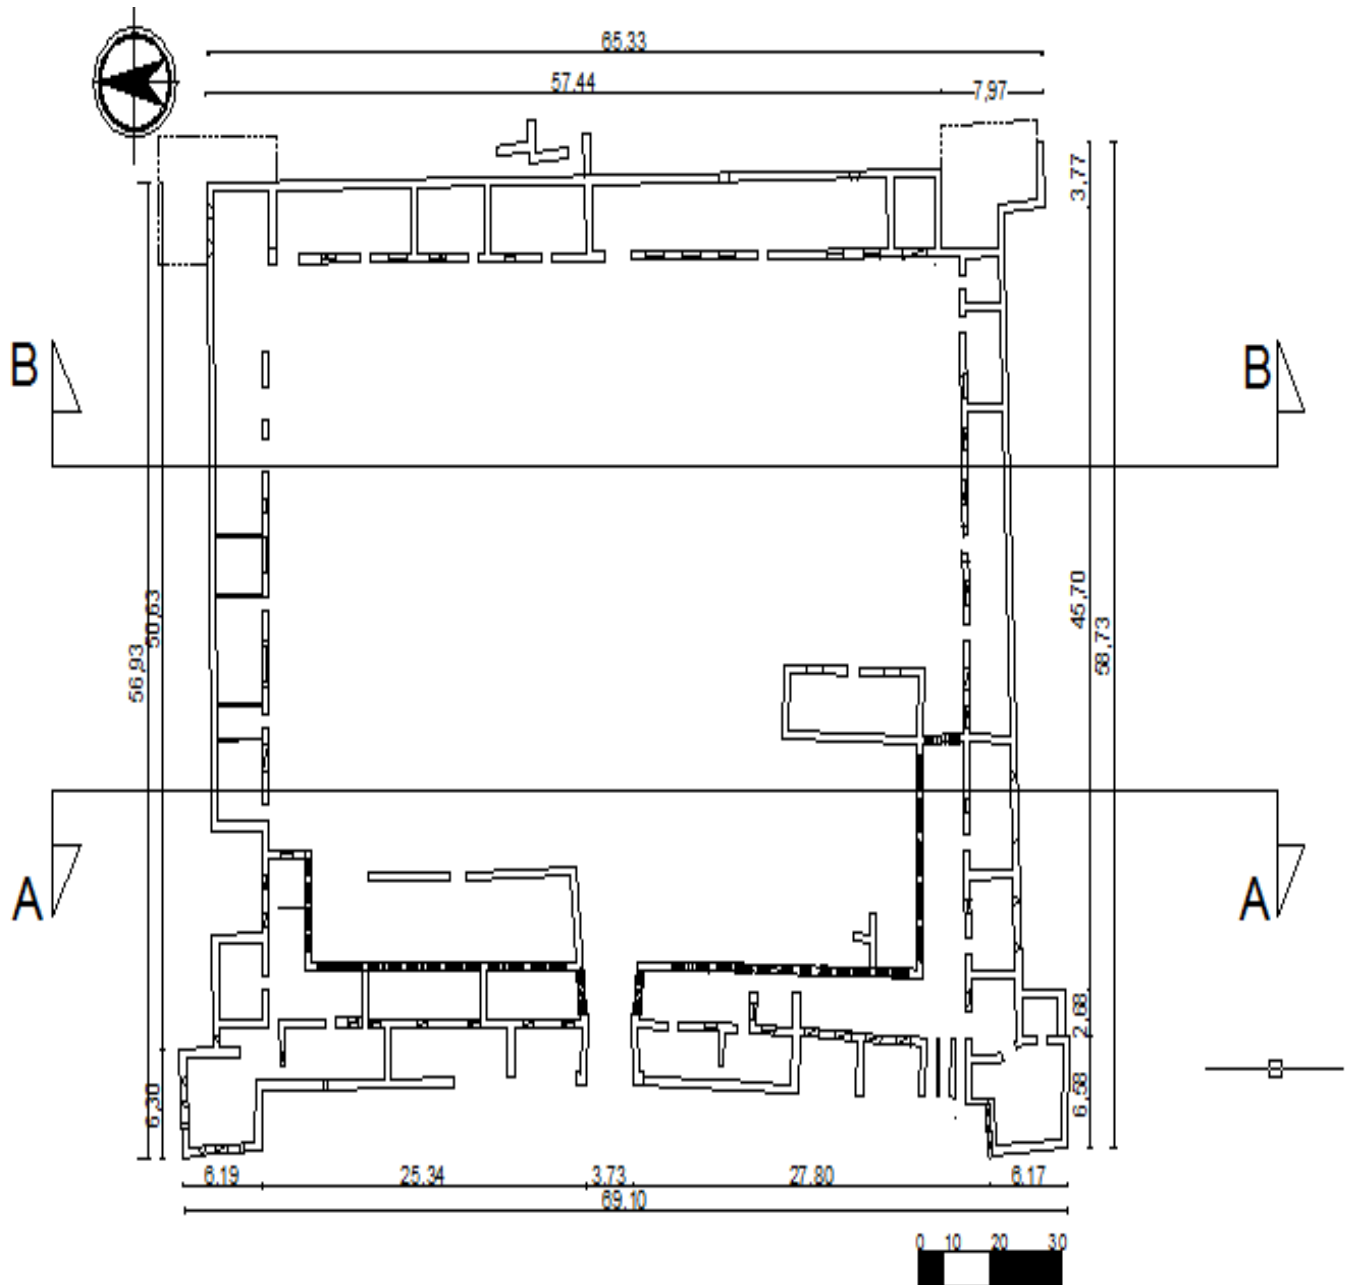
plan architecturale de l'état initial de Caravansérail de Sidi Makloof
